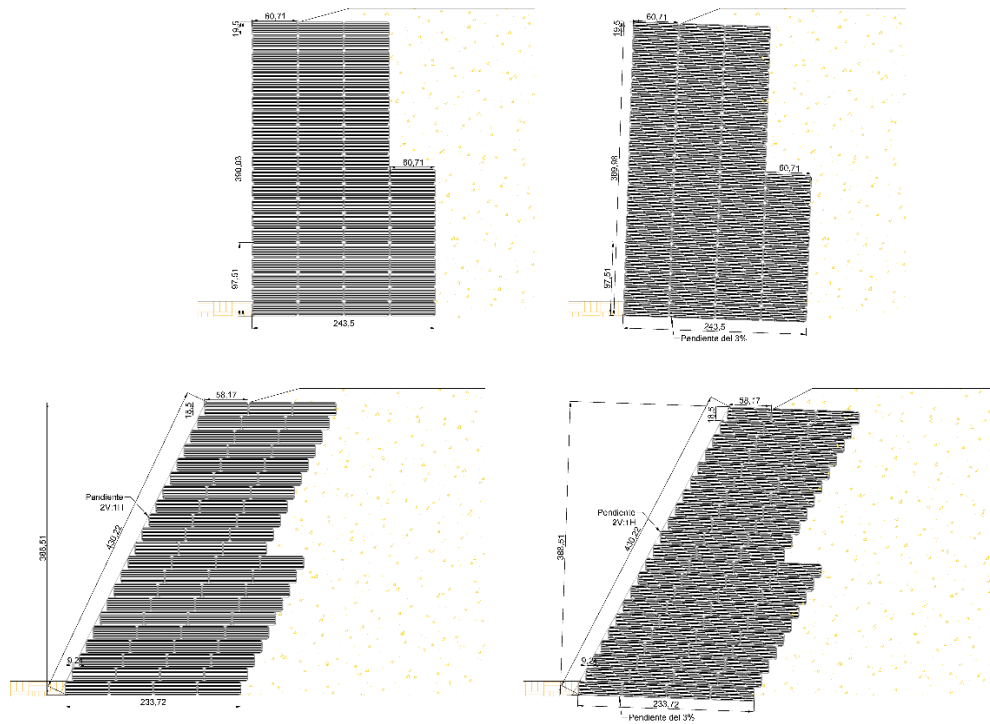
Detalles de muros con llantas de 4.0 metros de altura.
